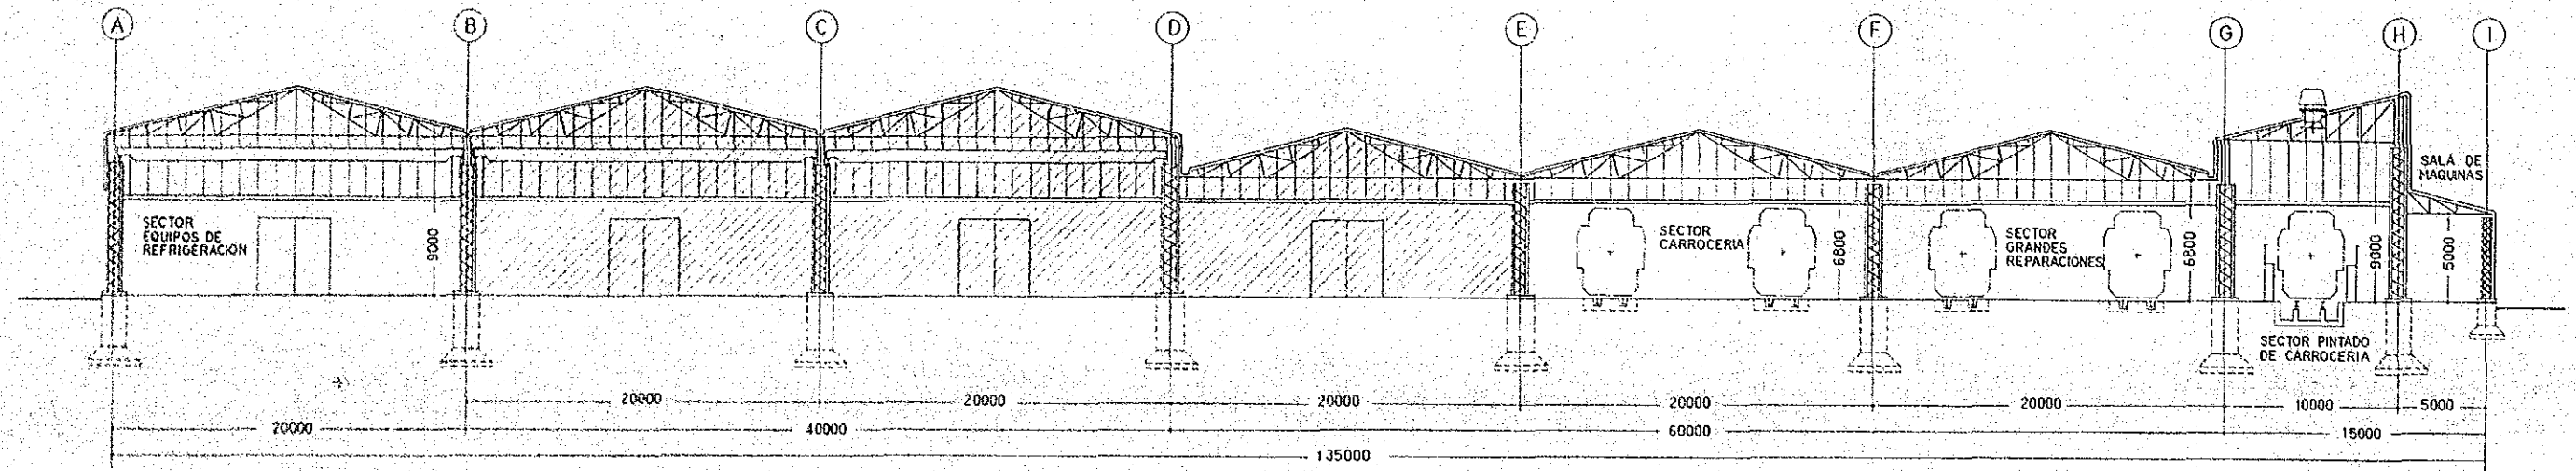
PLANTA DE SECTORES DE APLICACION (2/3) ESCALA 1:300
